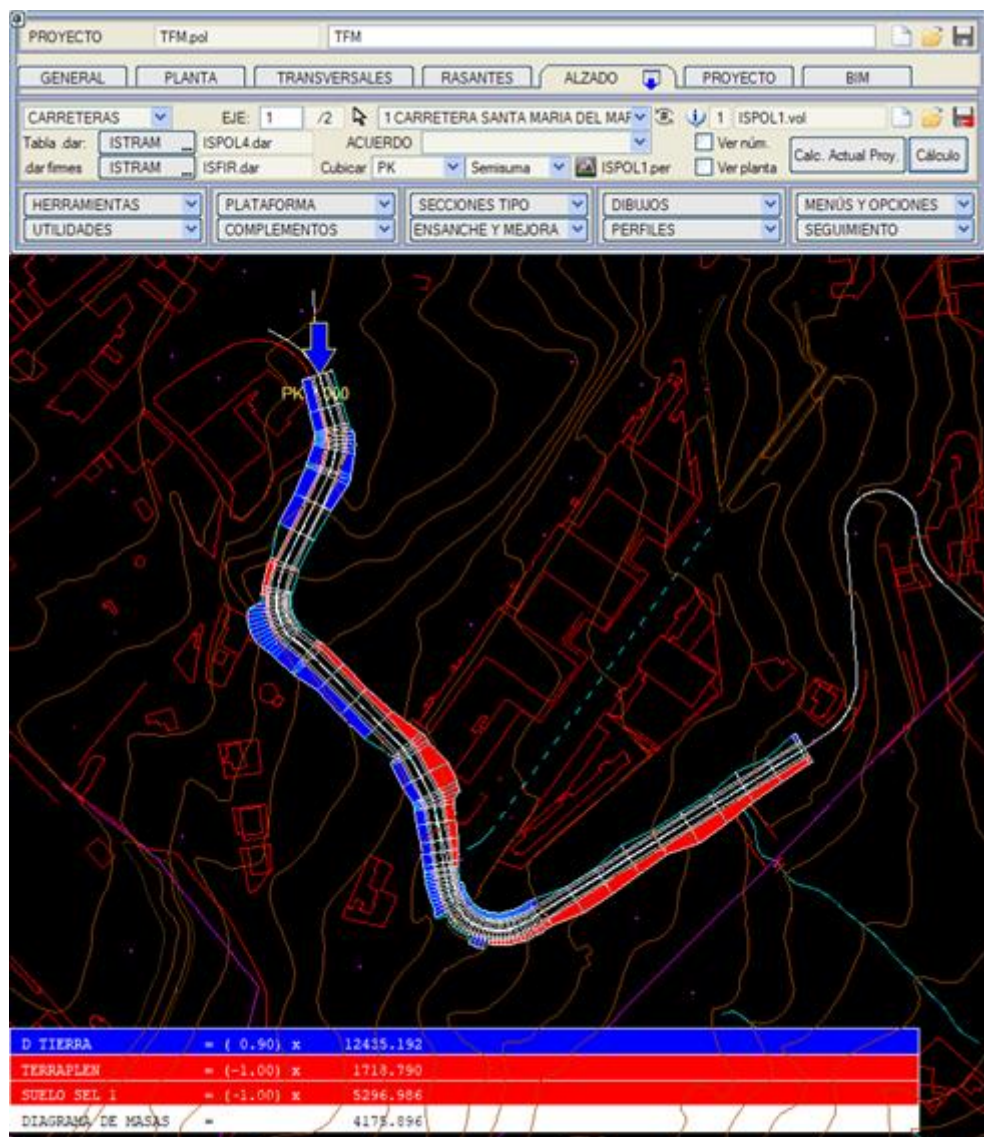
Menú de Alzado y eje 1 calculado. Fuente: Elaboración propia.
